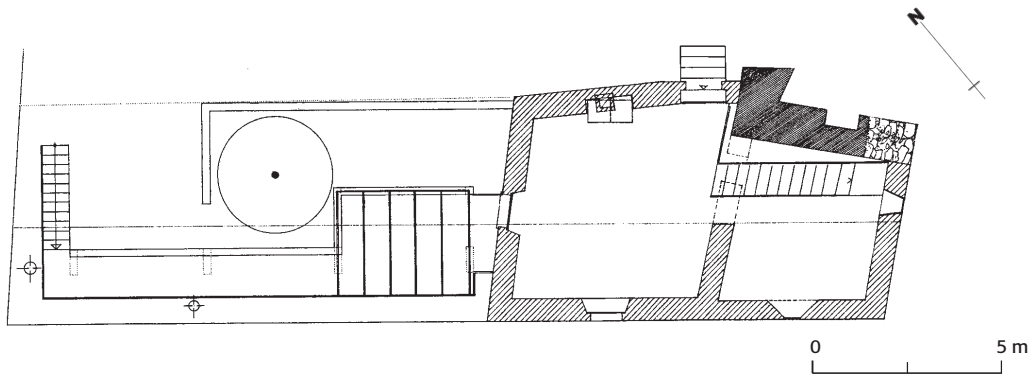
Roveredo, Palazzo Trivulzio. Wohnhaus Raveglia, Grundriss. Massstab 1:200.
